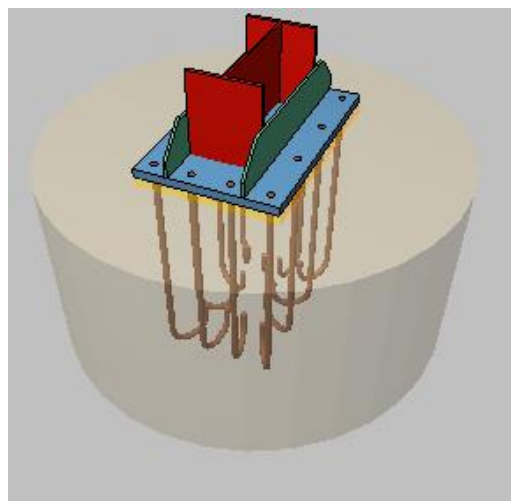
Placa anclaje pilares exteriores en CYPE 3D.
